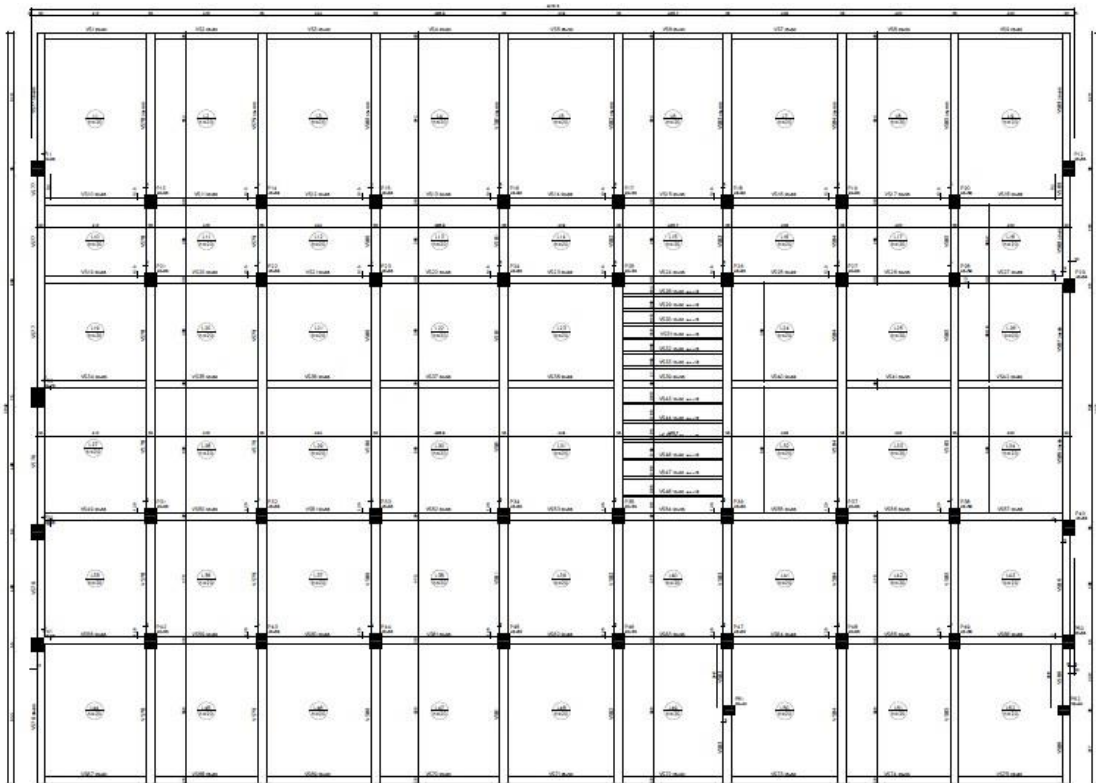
Planta de forma do pavimento superior da edificação. (Fonte:ECTA engenharia)
